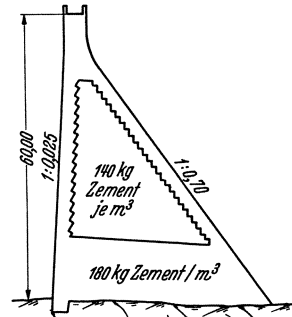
Bull-Run-Staumauer. Betonabstufung.
